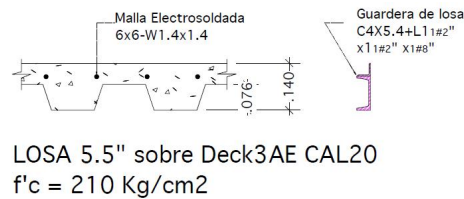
Detalle refuerzo de losa multiusos Edificio Buster Banco Ademi
